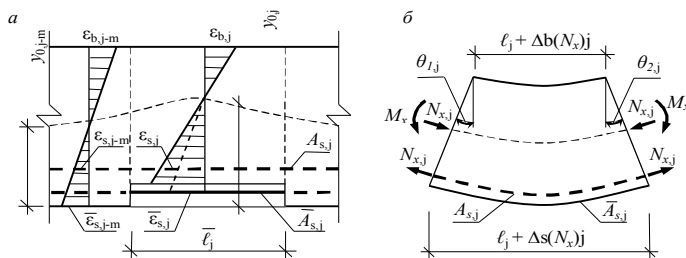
Розподіл деформацій в середньому перерізі *a* та розрахункова схема *б* залізобетонного елемента з порушеним зчепленням арматури та бетону
